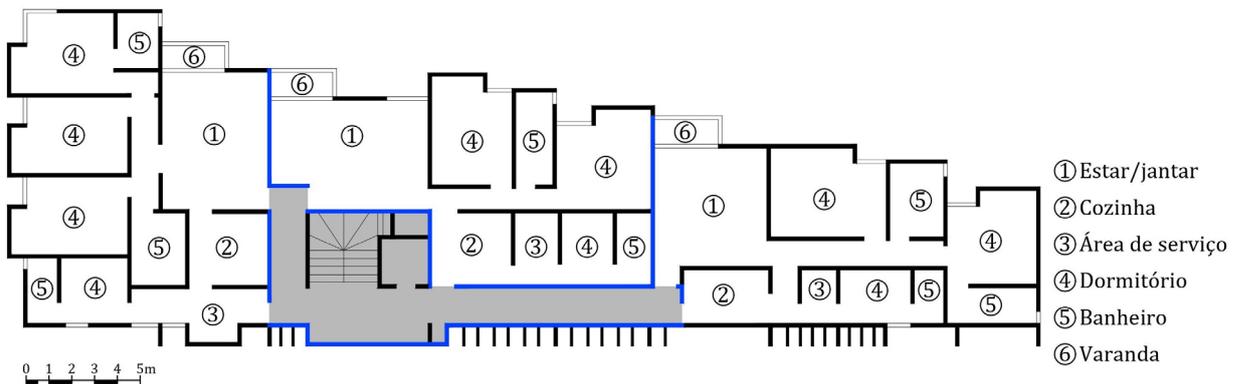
Planta do Objeto de estudo 3. Esquema sem escala.
